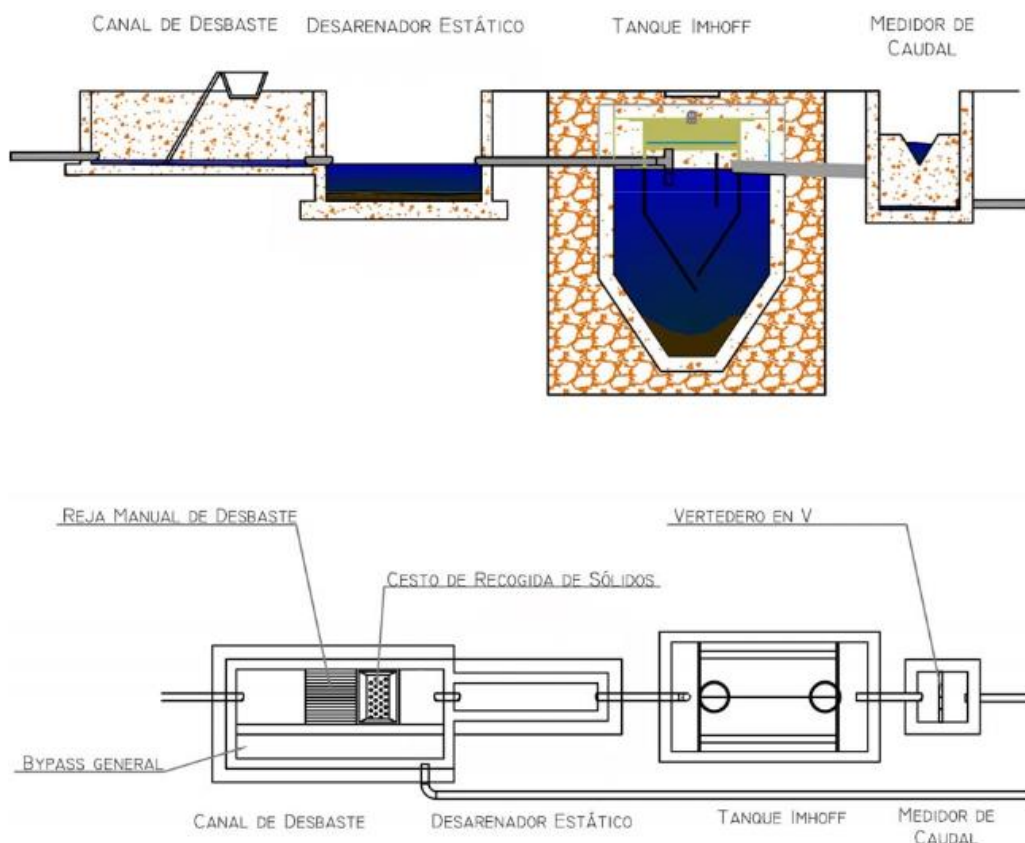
Diagrama de flujo en tanques Imhoff. Planta y perfil. Fuente: Ministerio de Fomento
